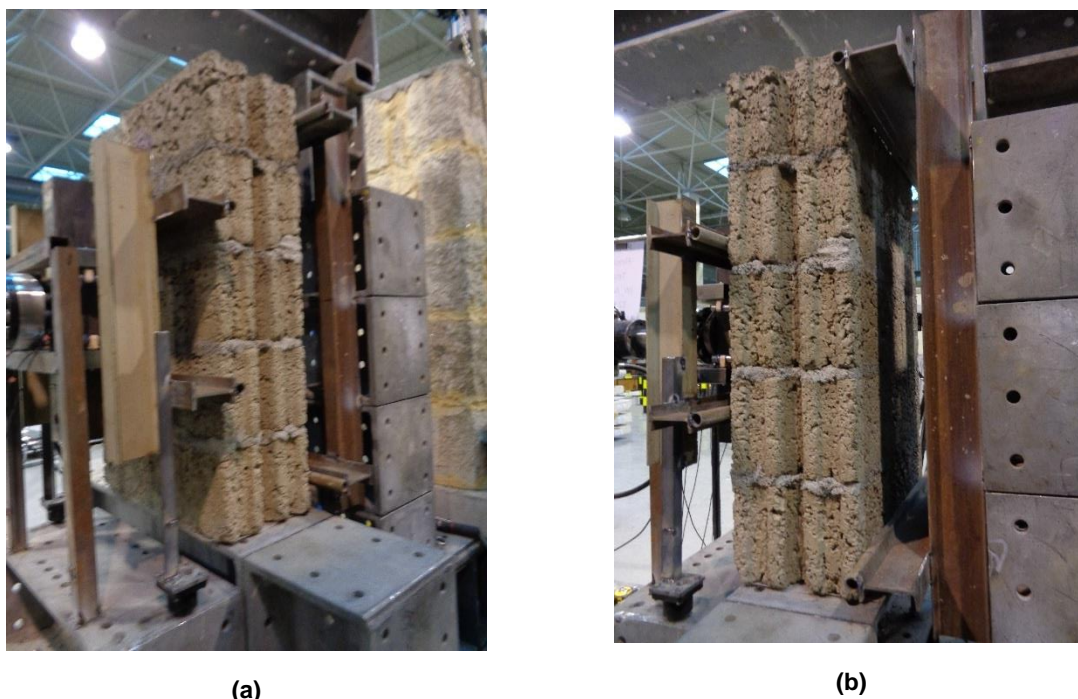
Pormenorização das zonas de aplicação de carga e de apoio dos provetes: (a) Lado da aplicação de carga; (b) Lado dos apoios.
